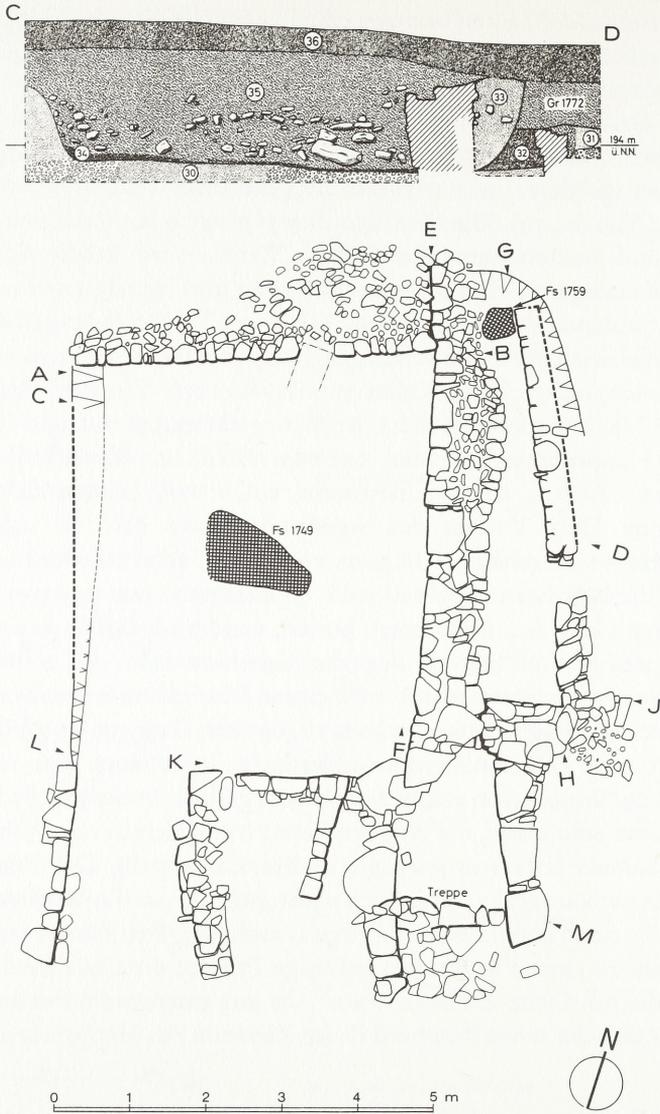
Wülfingen. Grundriß und Profil der Steinfundamentbauten IIa und IIb. – M = 1:100.
